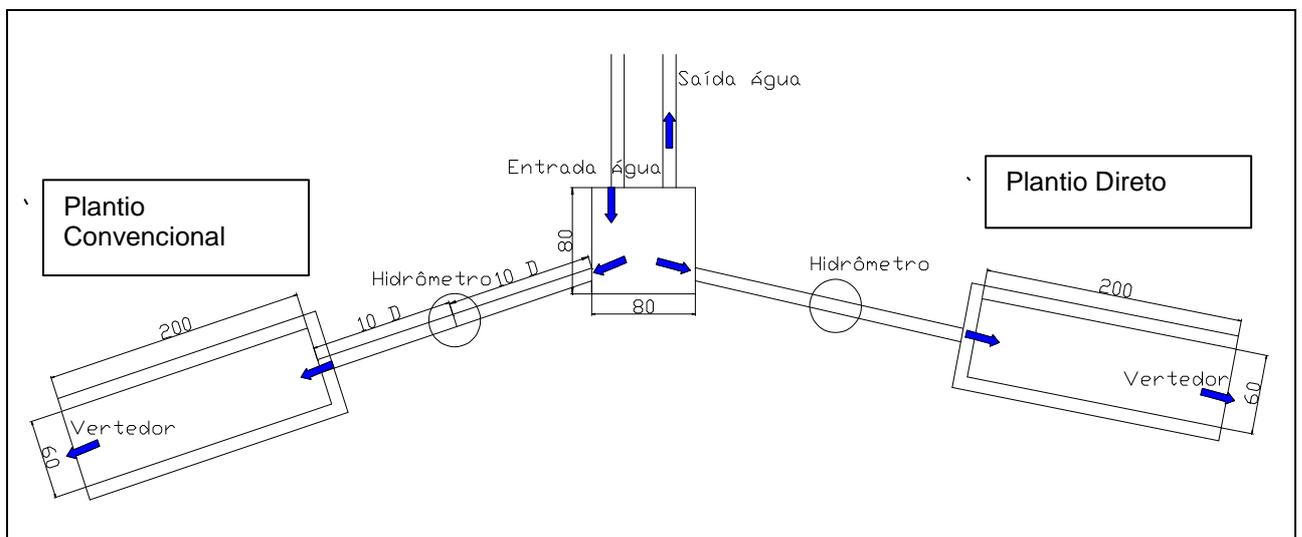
Planta Baixa do sistema “Vertedor x Hidrômetro”
